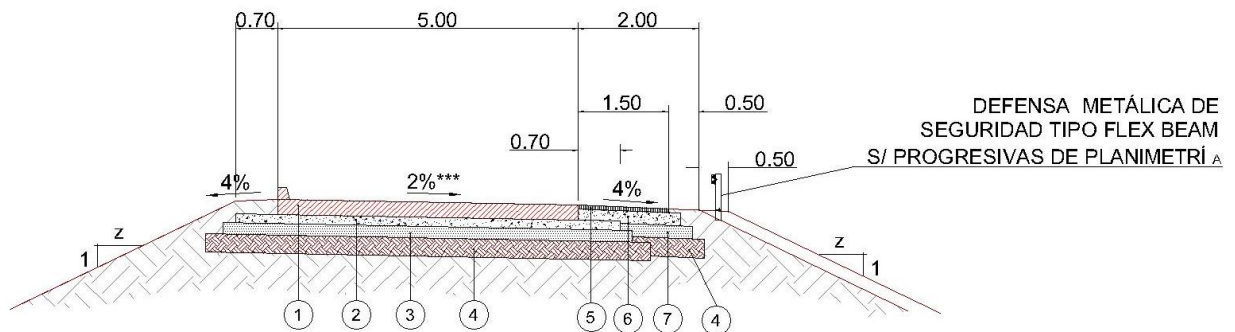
Perfil Tipo Ramas Rotonda.
